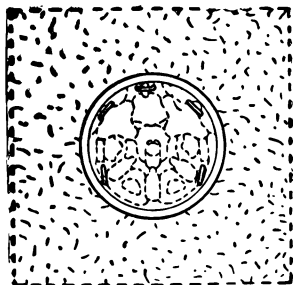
Укрепление грунта под опорную плиту подкладкой матов из ветвей
